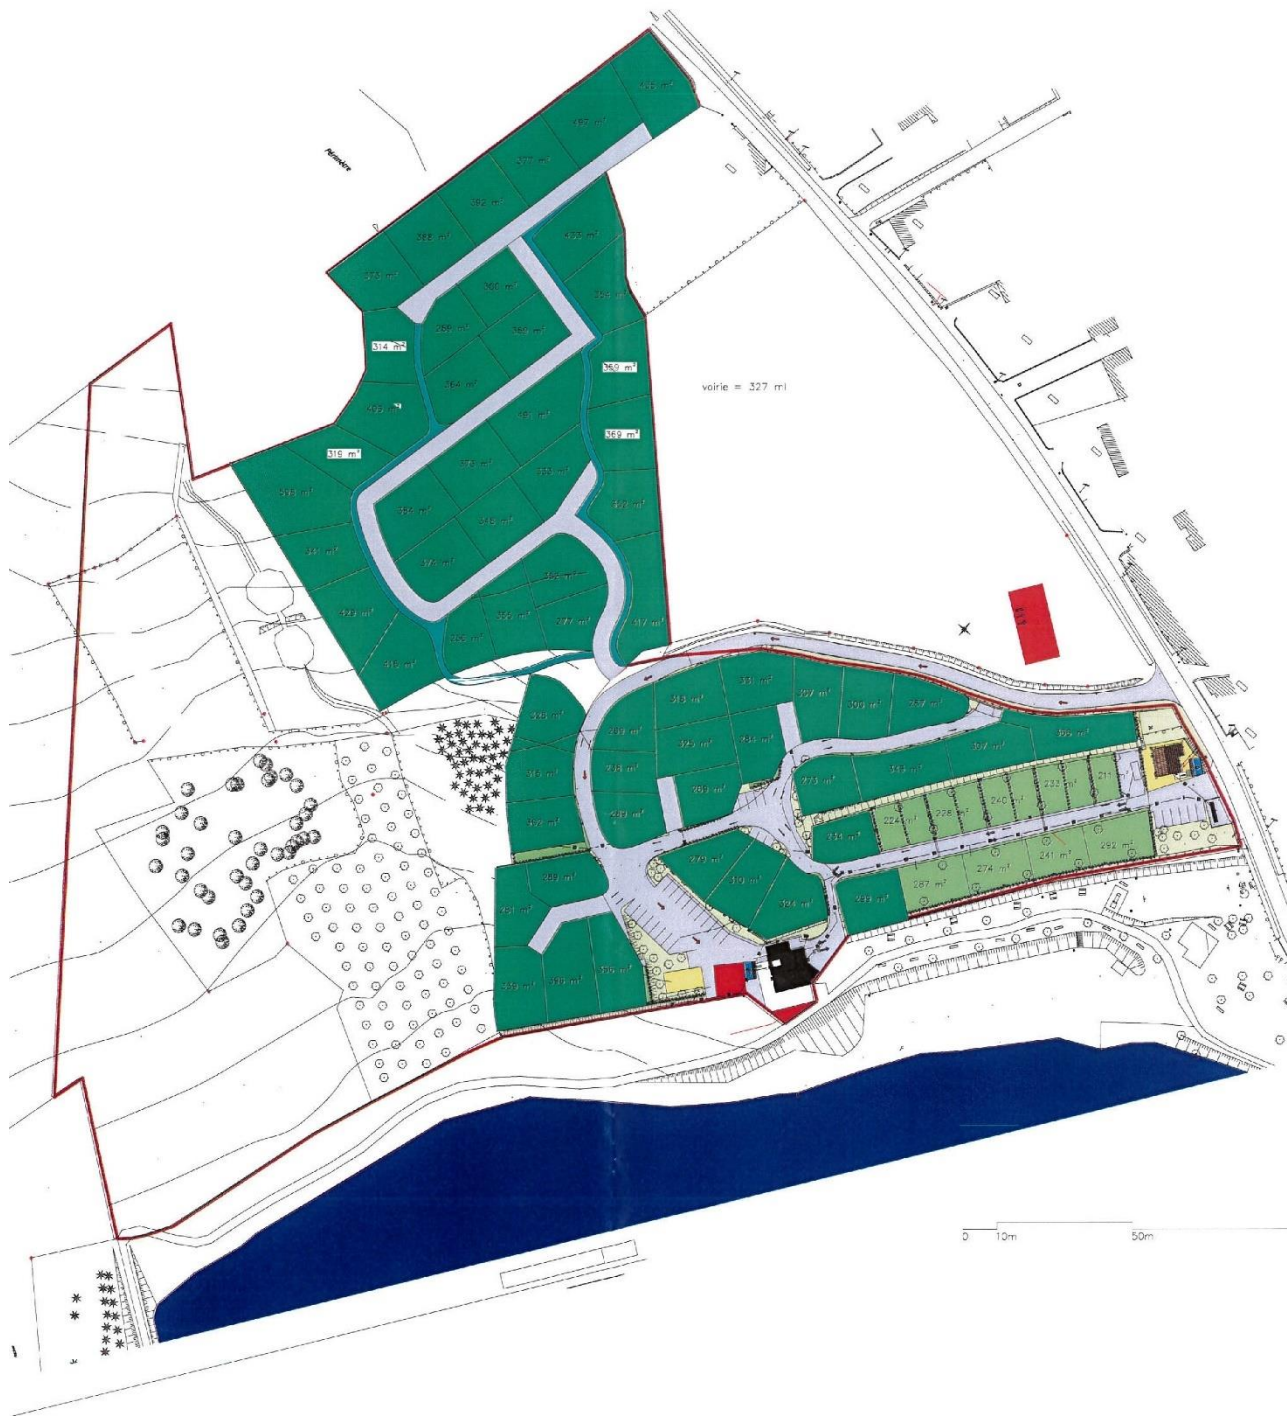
Plan d'aménagement : solution B1 (non retenue)
